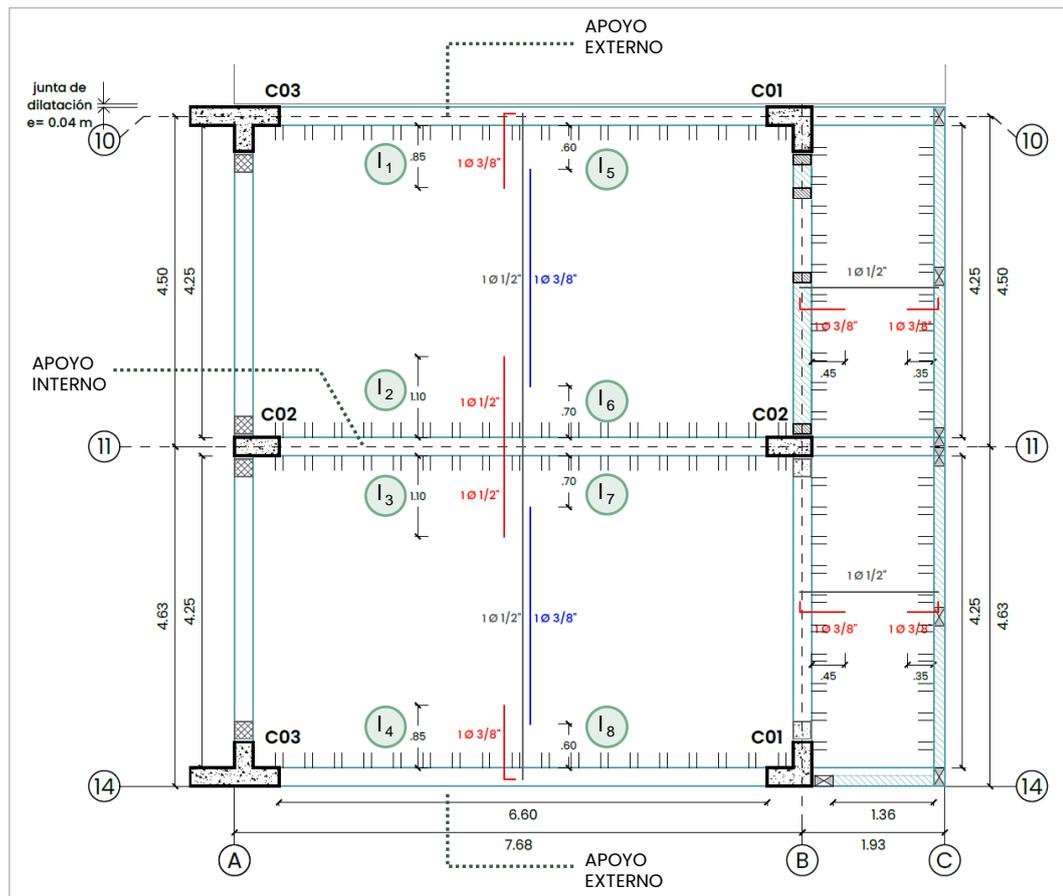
Losa Aligerada propuesta en Zona Educativa.
